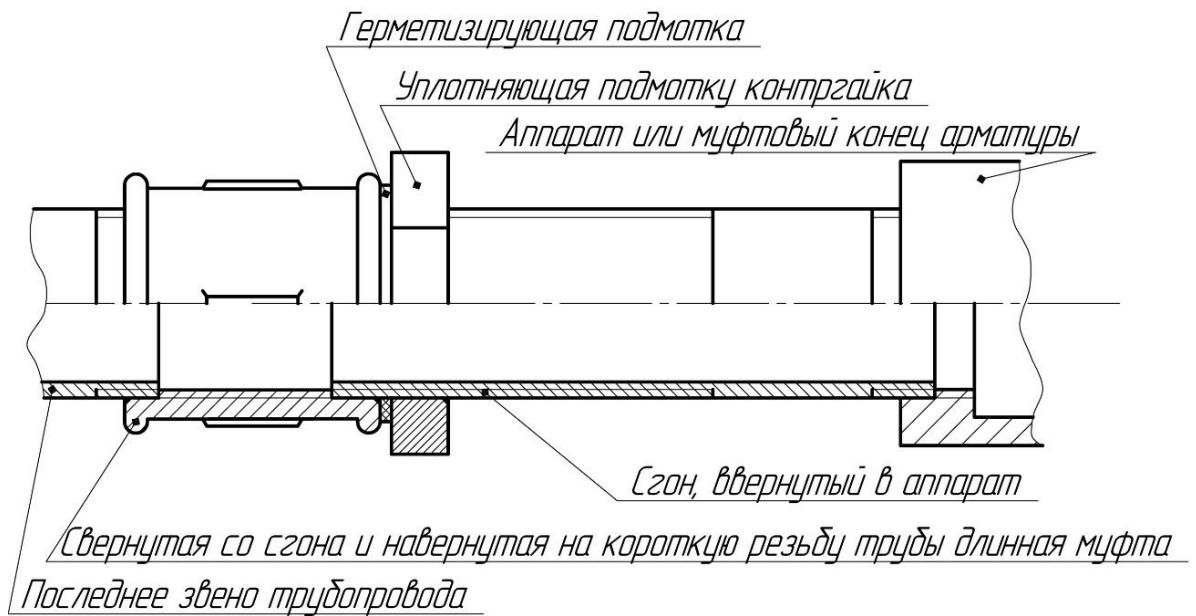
Монтаж арматуры сгоном. Включение сгоном оборудования или арматуры
